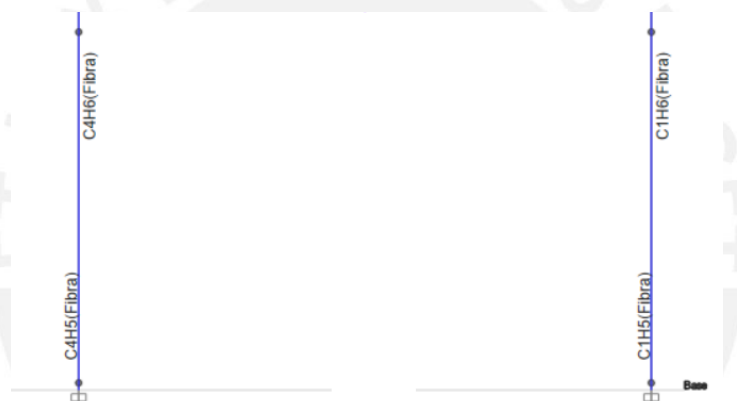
Columnas de confinamiento tipo fibra del primer piso (Fuente: propia)
